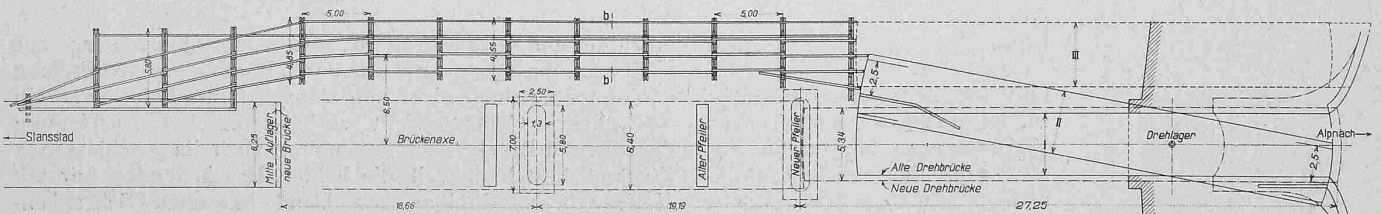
Grundriss der alten und neuen Brücke, sowie der Notbrücke mit Andeutung der Bauetappen I, II und III (rechts). — Masstab 1 : 500.
